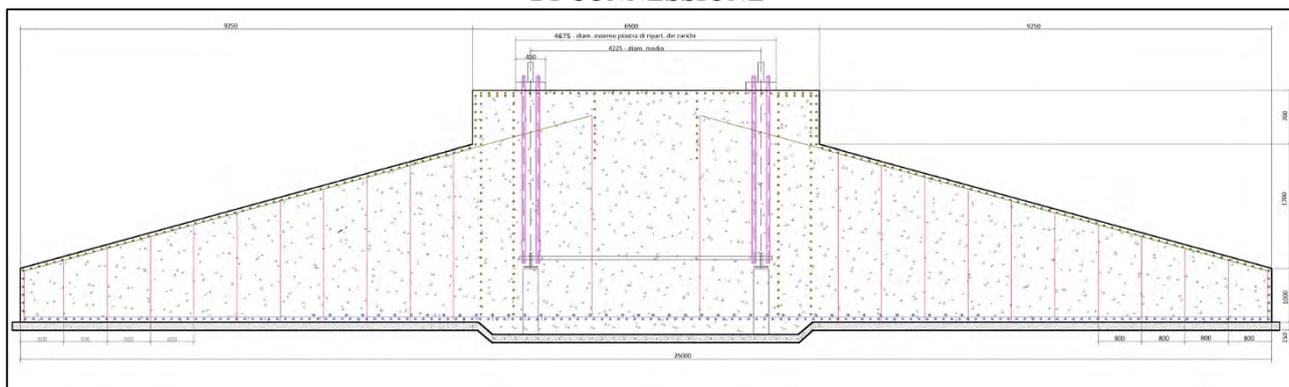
stralcio progettuale della fondazione dell'aerogeneratore
